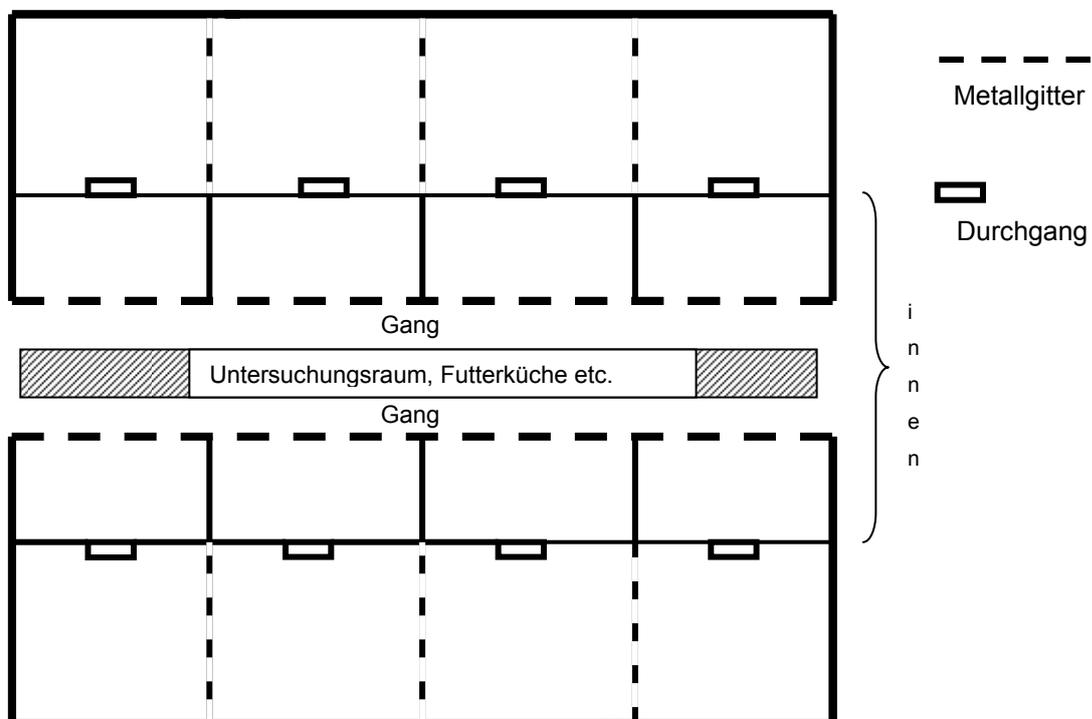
Grundriss des Innen- und Außenbereichs der Einrichtung D, unter besonderer Berücksichtigung von sichtdurchlässigem Material (Gitter) und feststehendem Enrichtment
